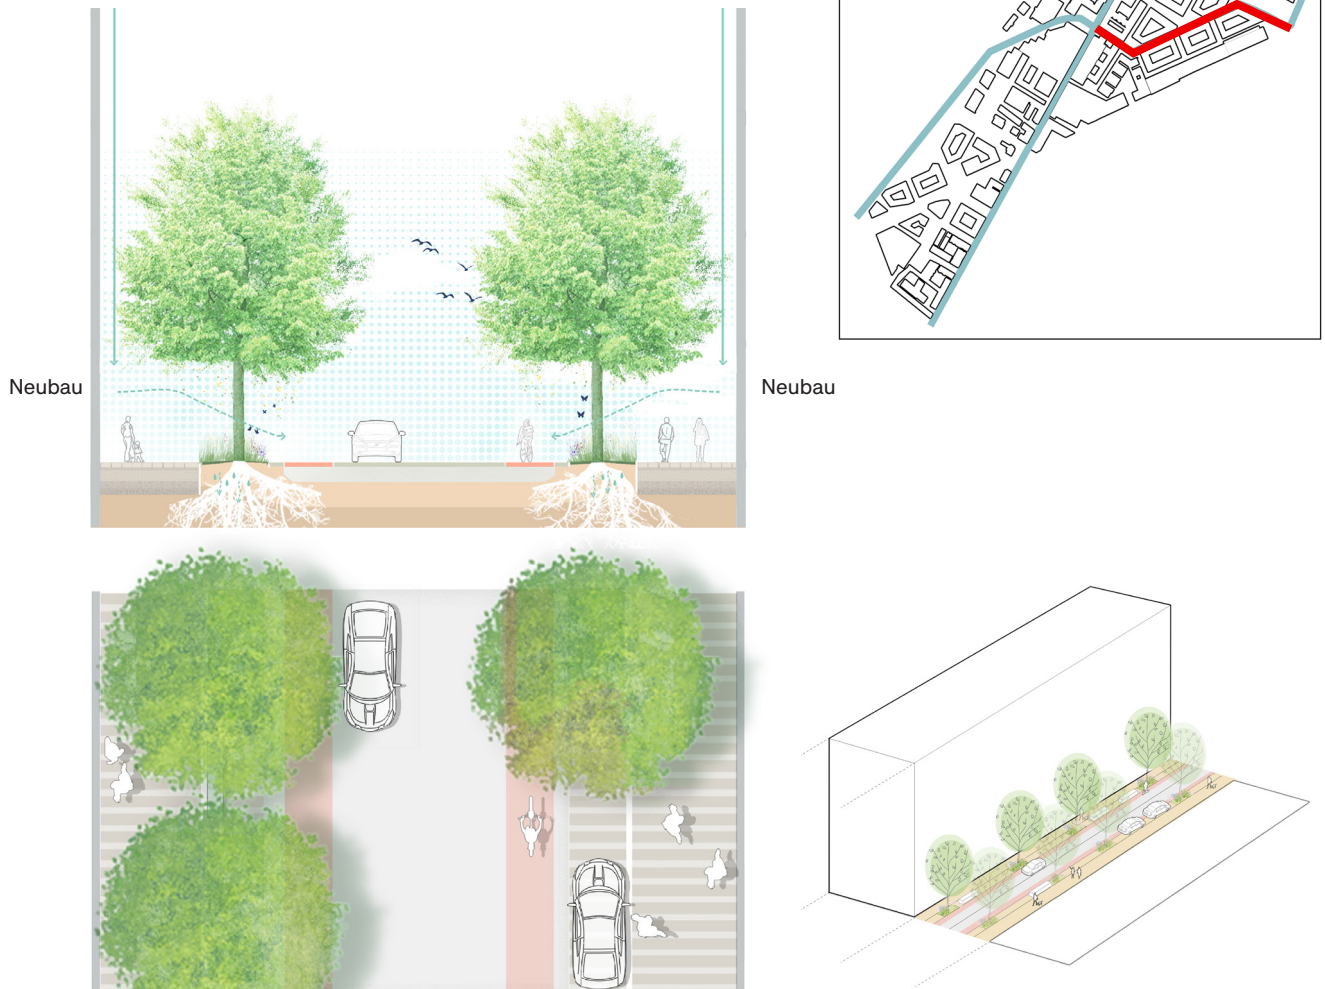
Schnitt, Verortung und Axonometrie Planstraße A
